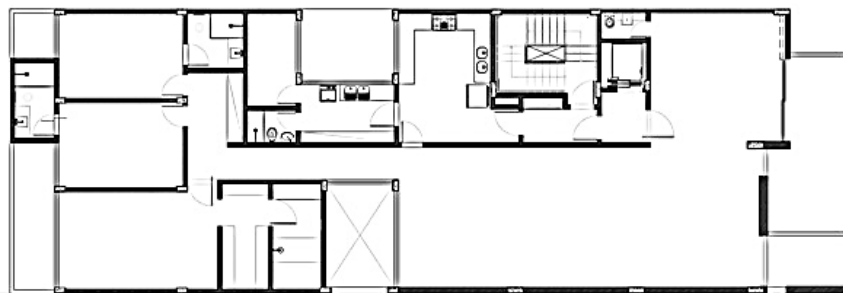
Ed. Maiorca, pavimento tipo, um apartamento por andar.
